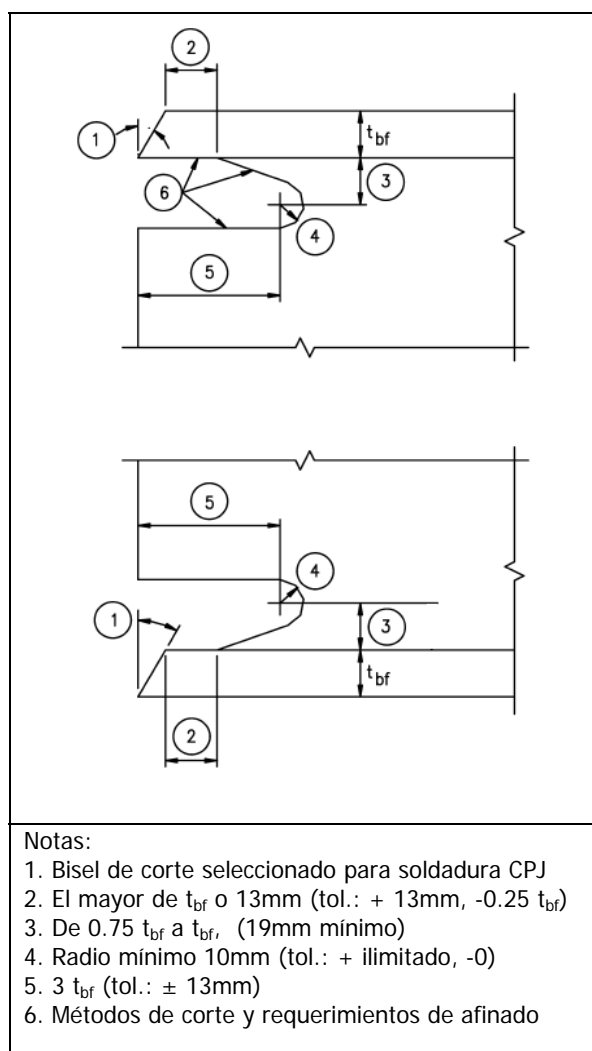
Requisitos de aberturas de acceso para soldadura
